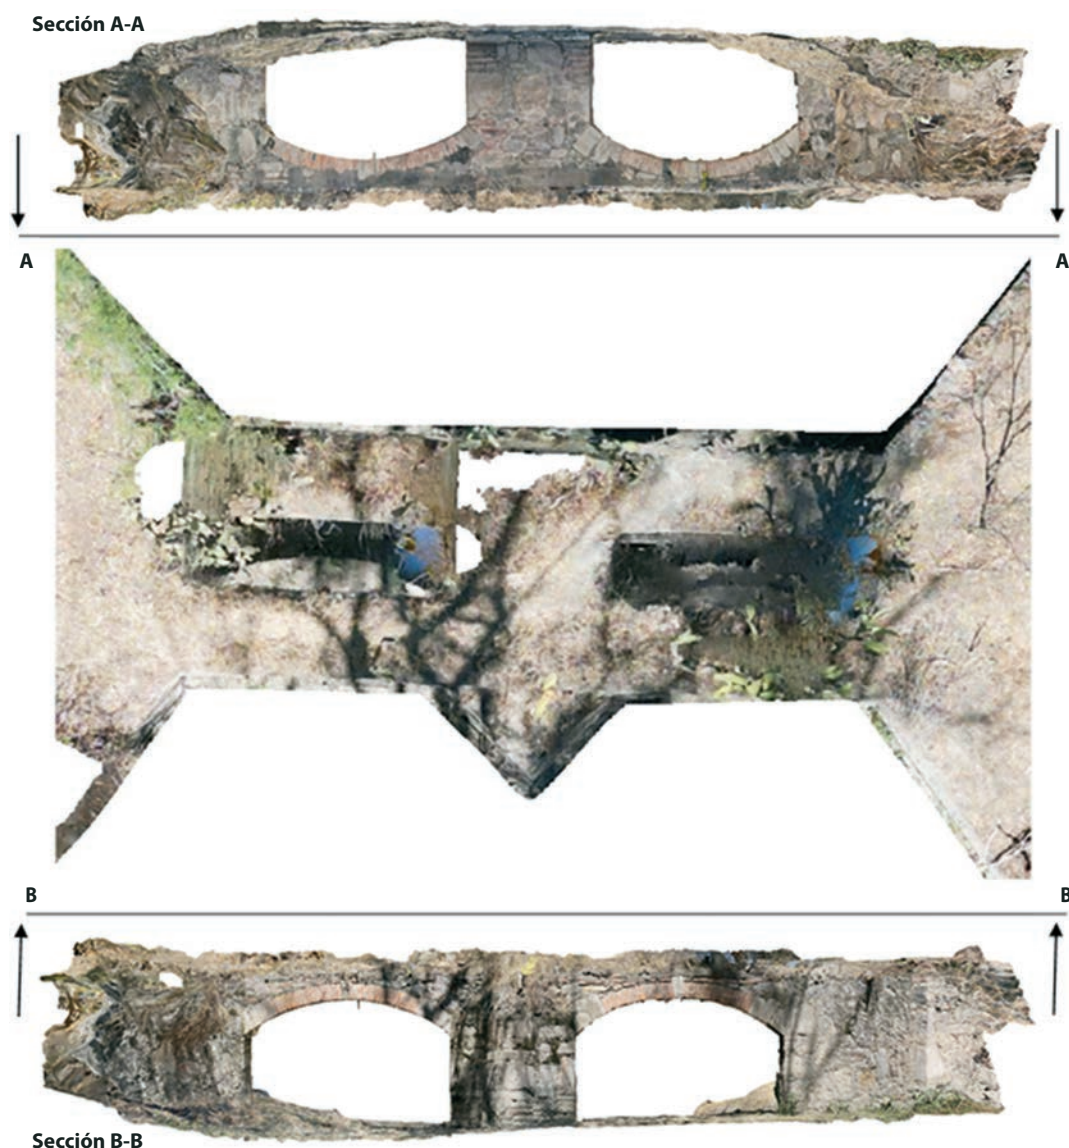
Ortofotos de planta y fachadas del puente Peñuelas.
